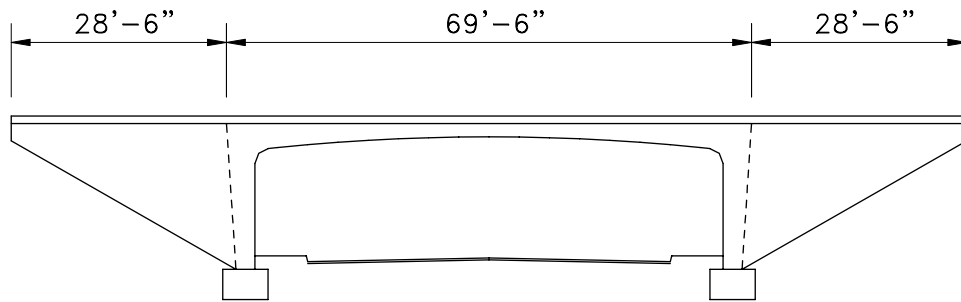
Pont d'étagement de l'autoroute 20 à Laurier
